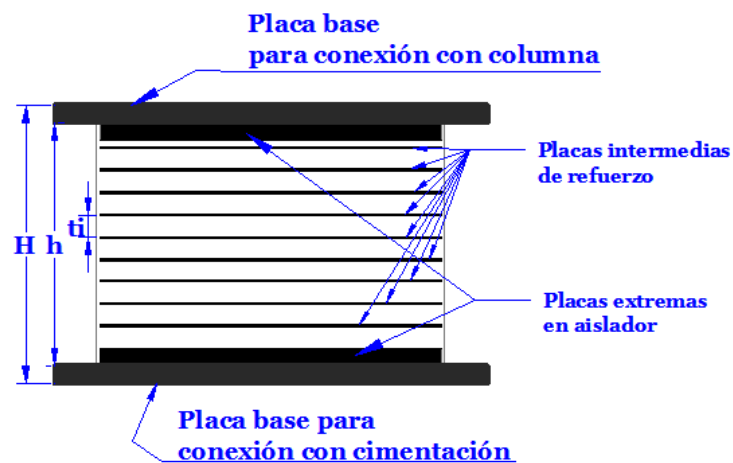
Dimensiones y elementos de un aislador elastomérico laminado (Planta)
